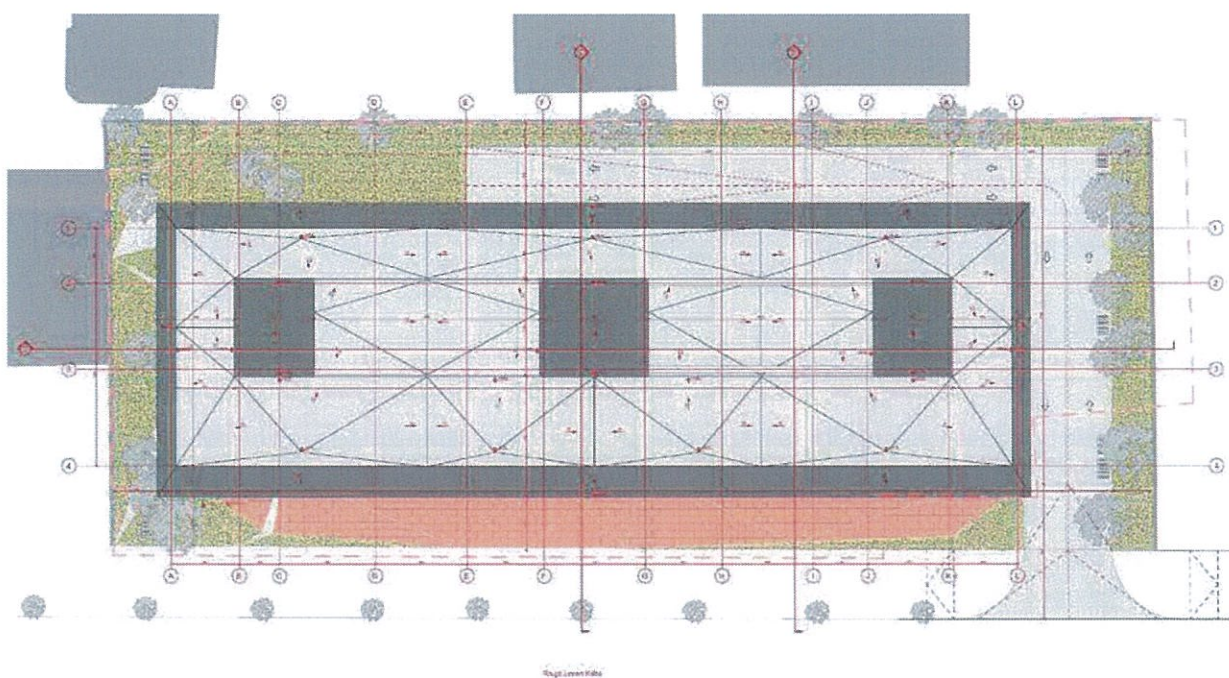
Plani i hapësirave të jashtme të objektit të propozuar
